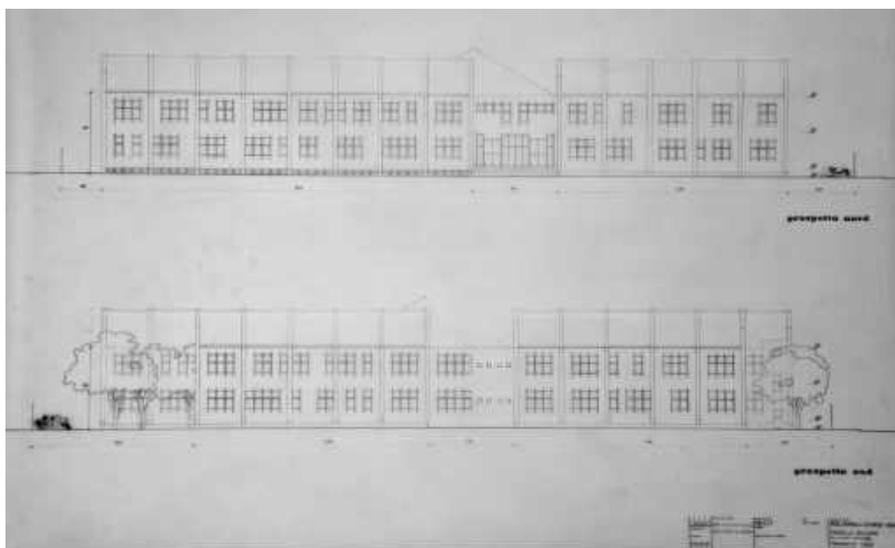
Prospetto nord, prospetto sud; tavola su lucido
